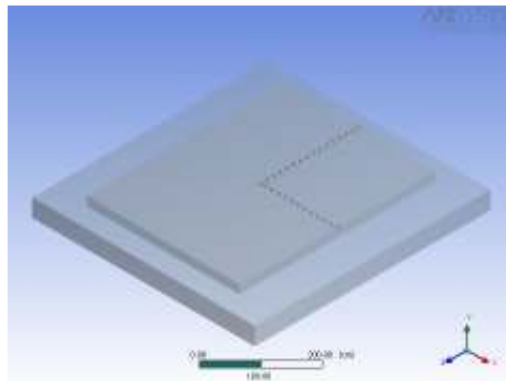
Pontos de aplicação das cargas concentradas para a escolha da pior situação.
